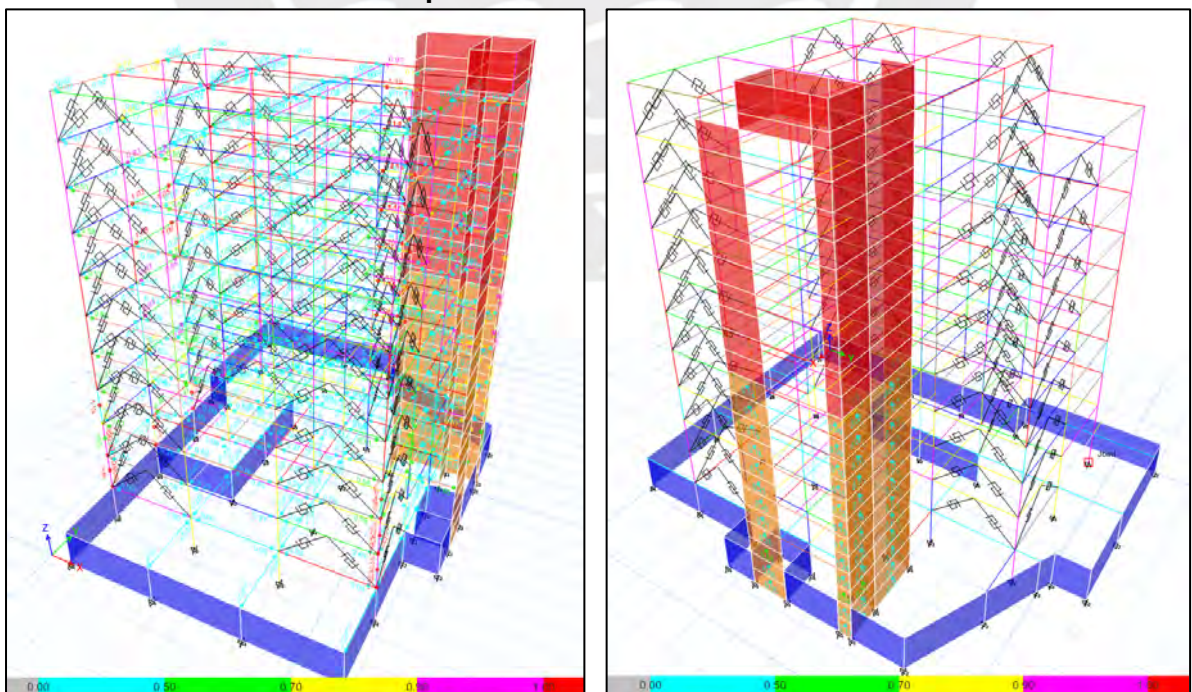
Imágenes de las vigas, columnas y placas para Ocupación Inmediata
